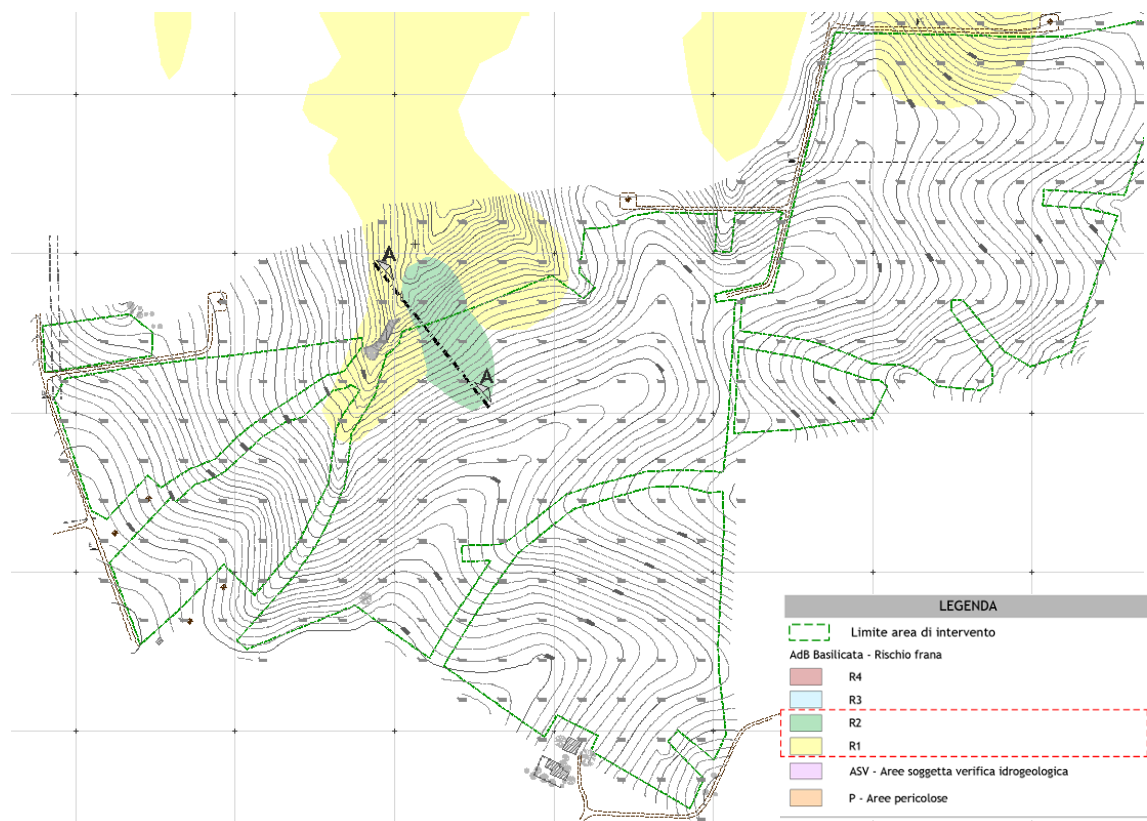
Planimetria area intervento con individuazione dell'area a rischio idrogeologico
